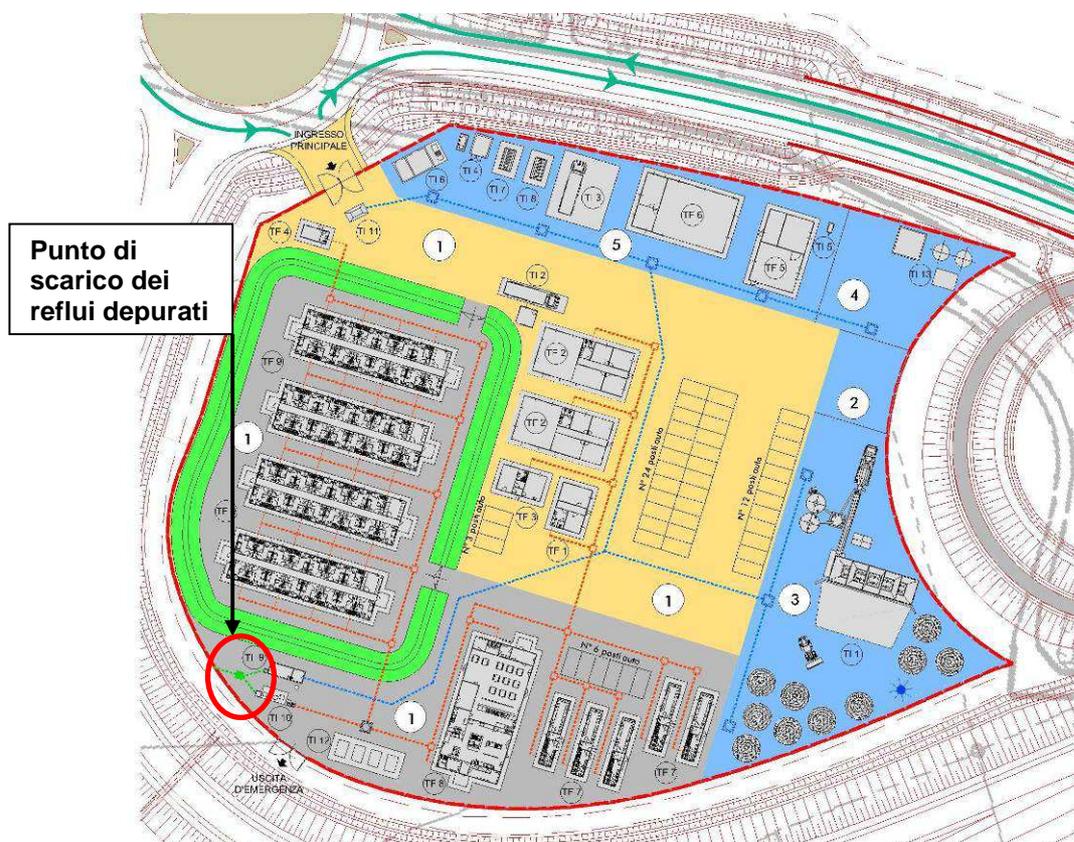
STRALCIO PLANIMETRICO DEL CAMPO BASE CON INDIVIDUATO IL PUNTO DI SCARICO DEI REFLUI DEPURATI
